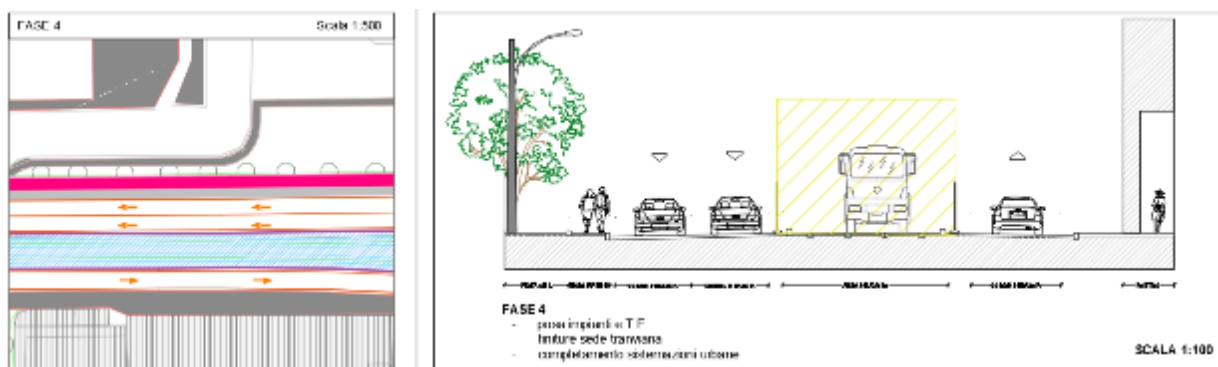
Tipologico cantiere con sede centrale Fase 4
